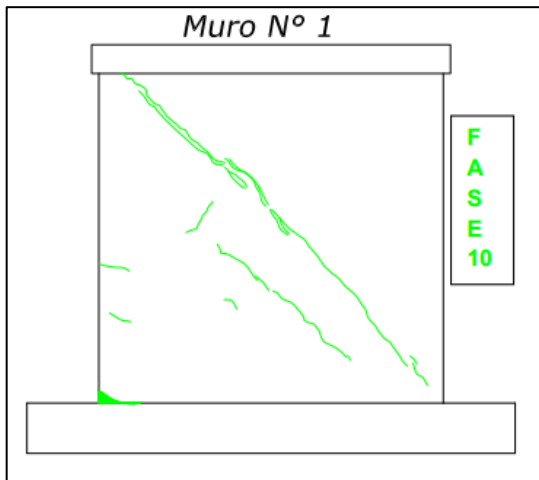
Fisuras muro M-1 en fase 10.
